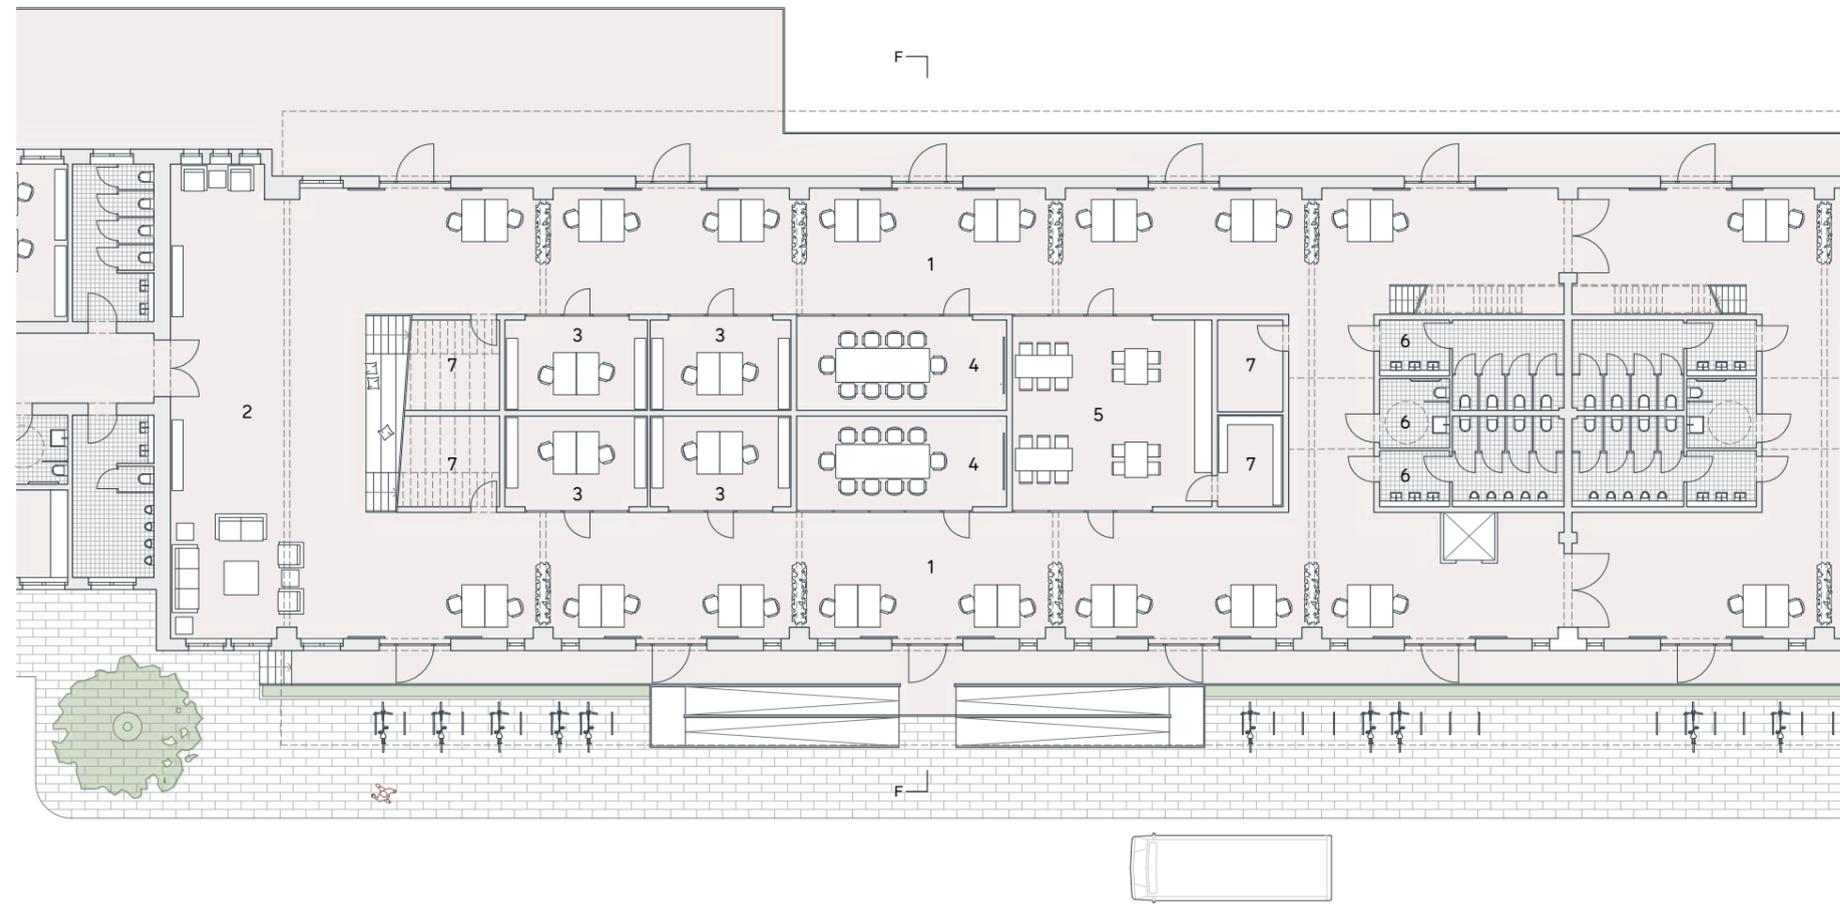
Stückgutschuppen: Co-Working-Space, Halle 1, Erdgeschoss M 1:250
